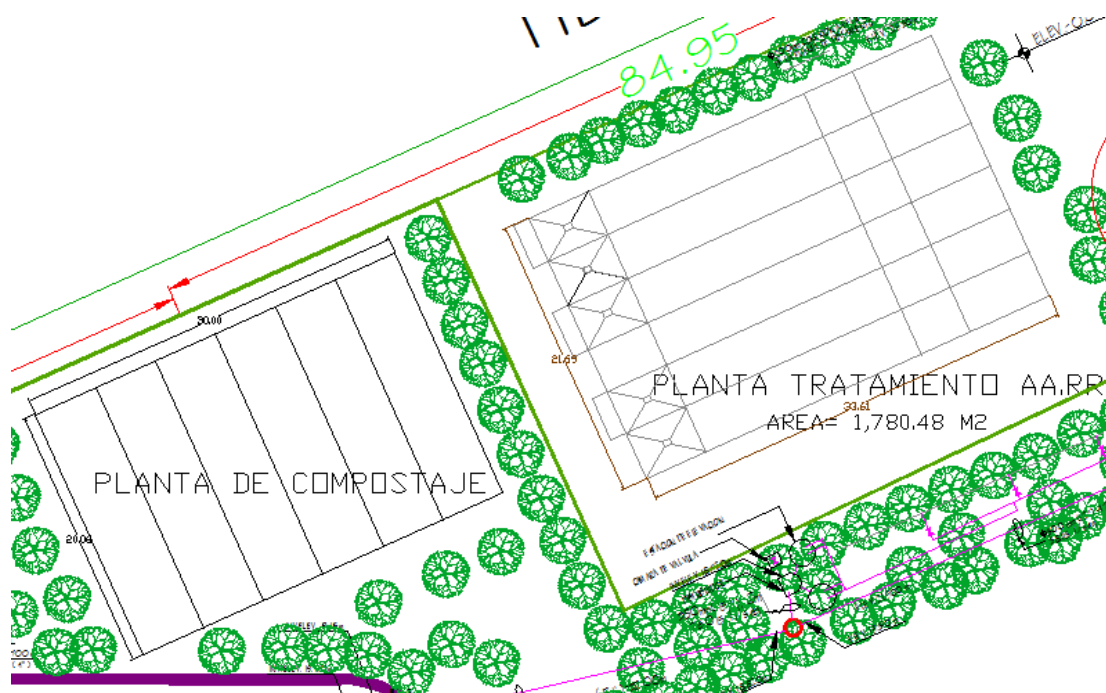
Vista en planta de la planta de tratamiento de aguas residuales.
